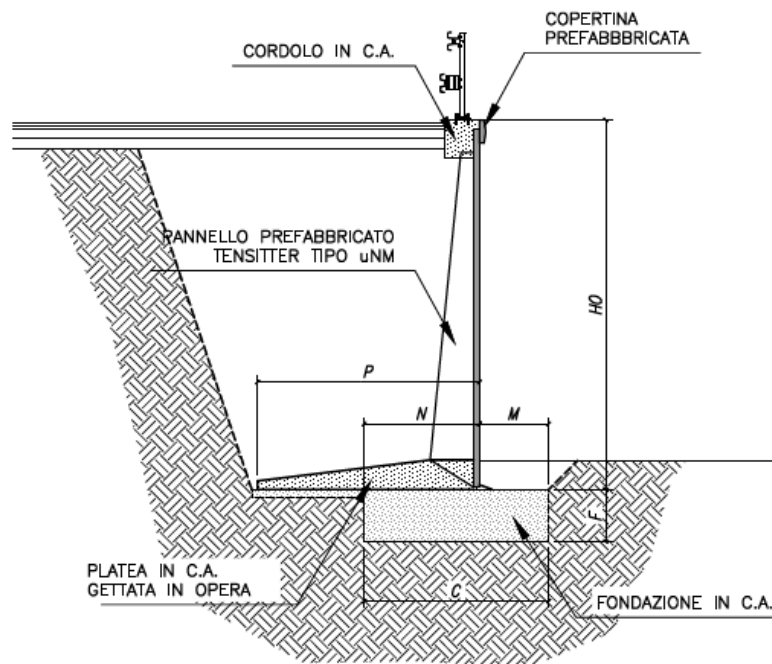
Sezione tipologica muro prefabbricato di tipo “uNM”
